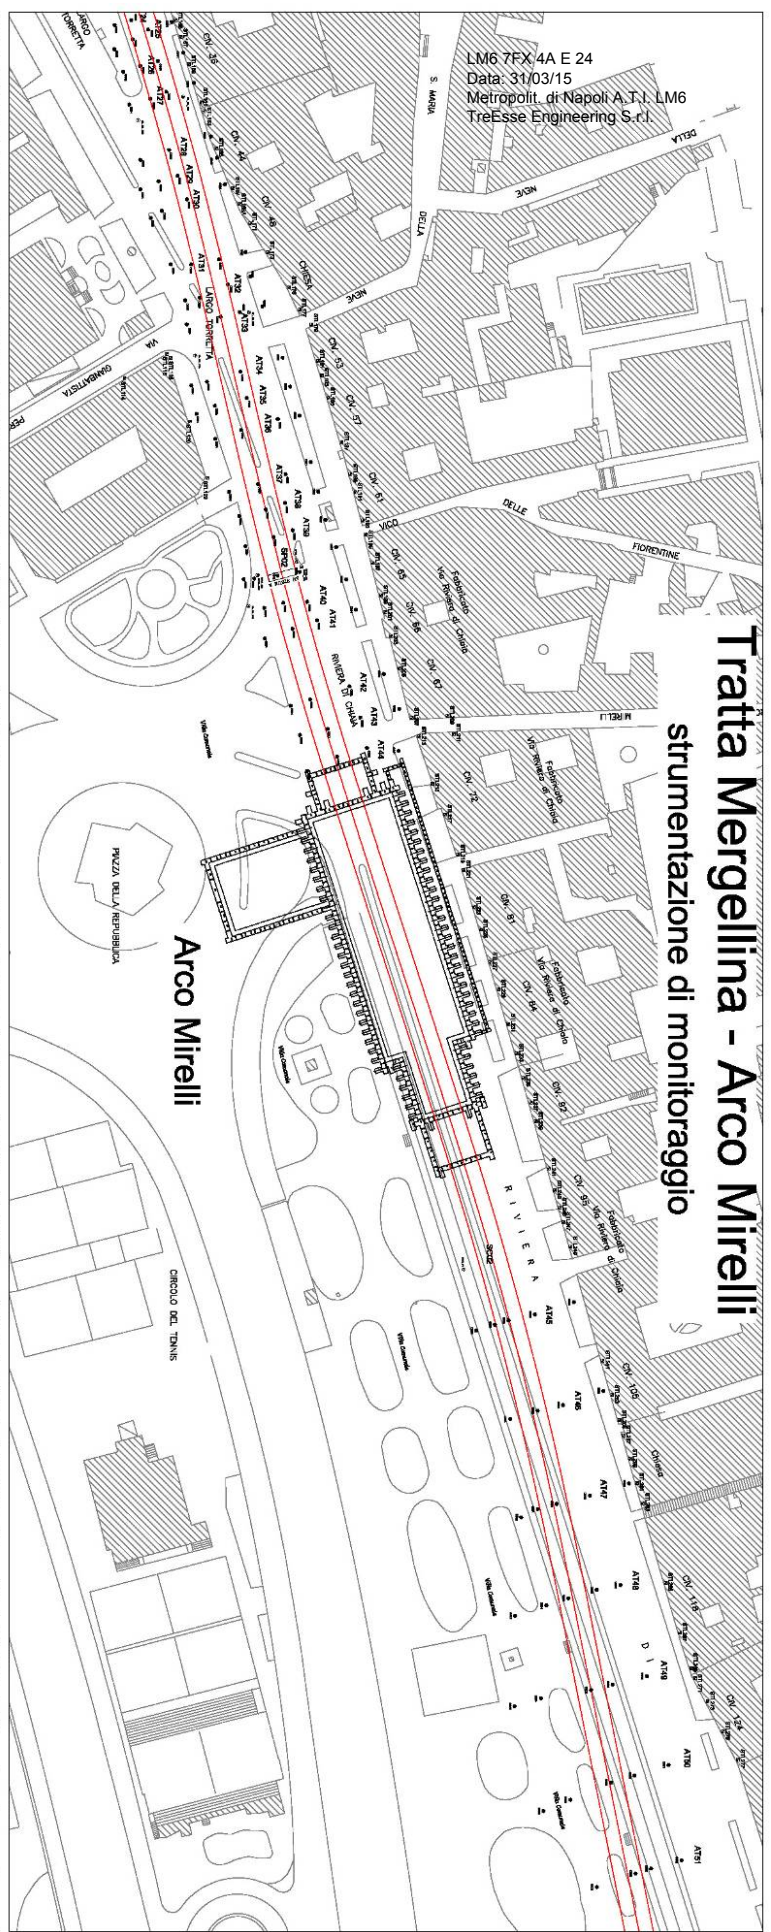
Planimetria tratta Mergellina - Arco Mirelli, raffigurante la disposizione della quarta installazione della strumentazione di monitoraggio.
